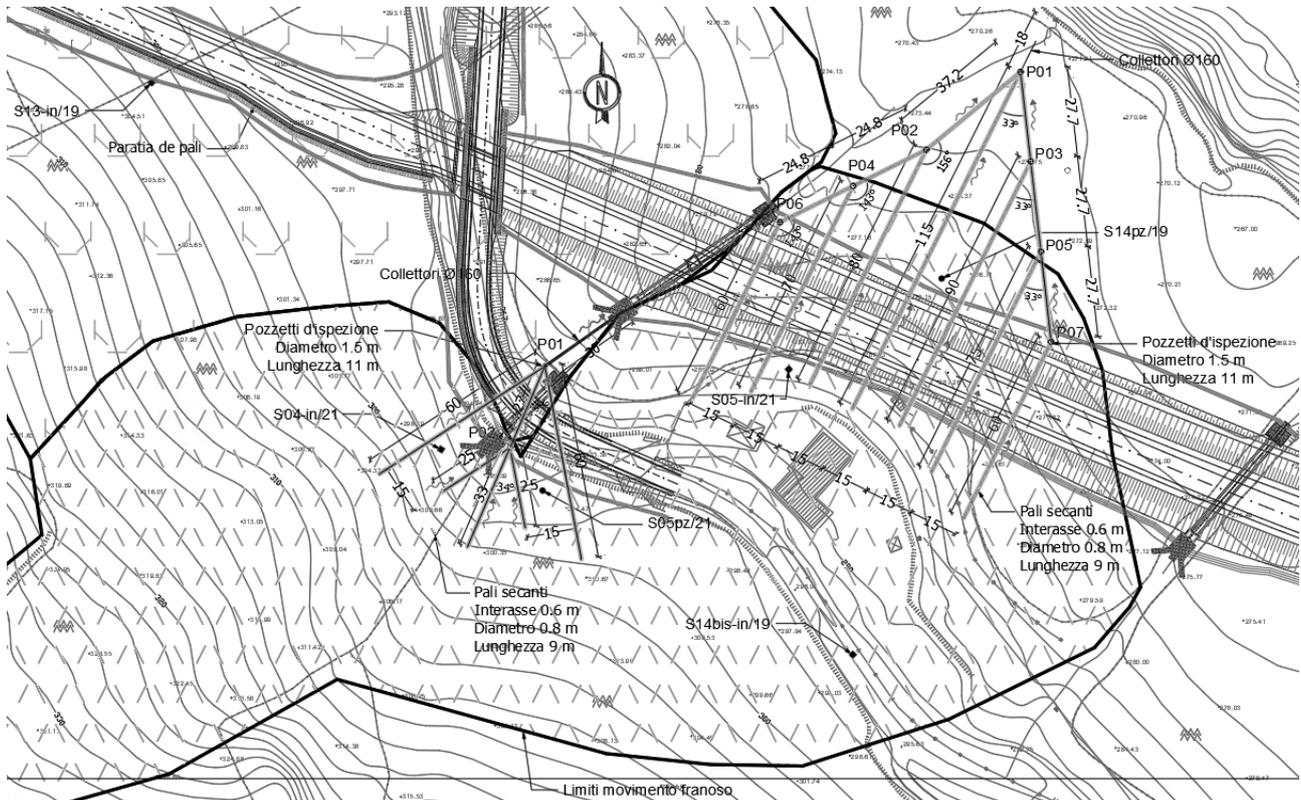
Schema della disposizione in pianta del sistema drenante costituito da pali secanti
